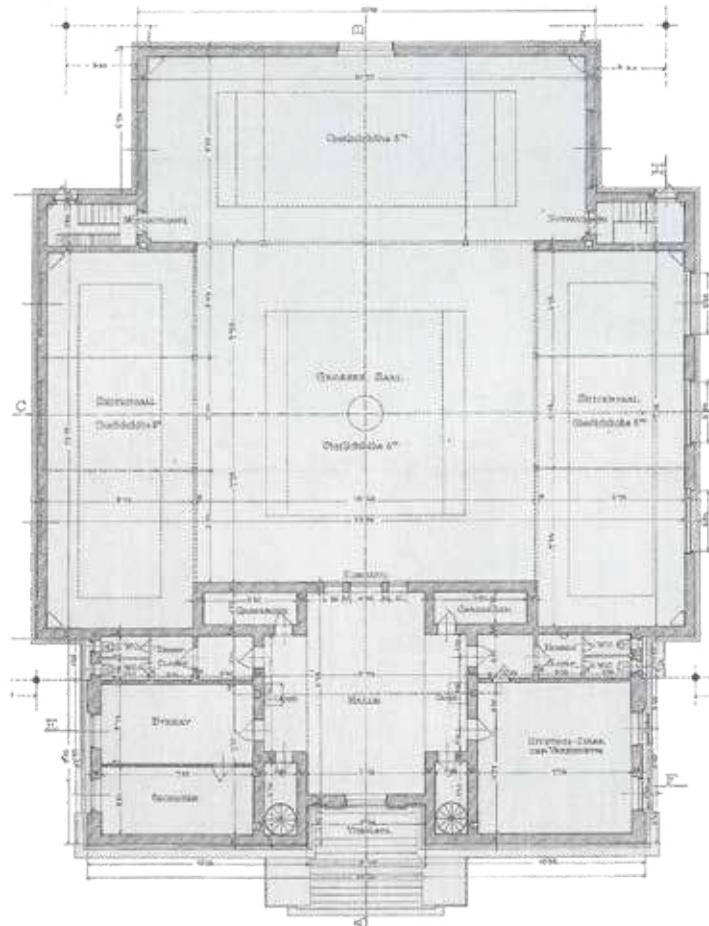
Grundriss Erdgeschoss Maßstab ca. 1:350
